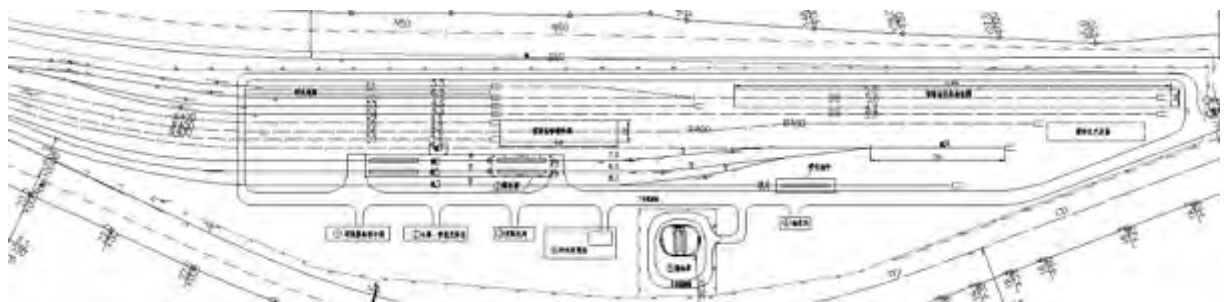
南沙港动车存车场及机务折返所总平面布置图
